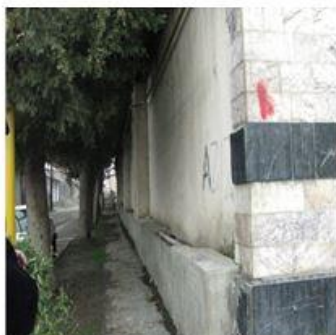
Отсутствие в некоторых местах бетонных плит покрытия
